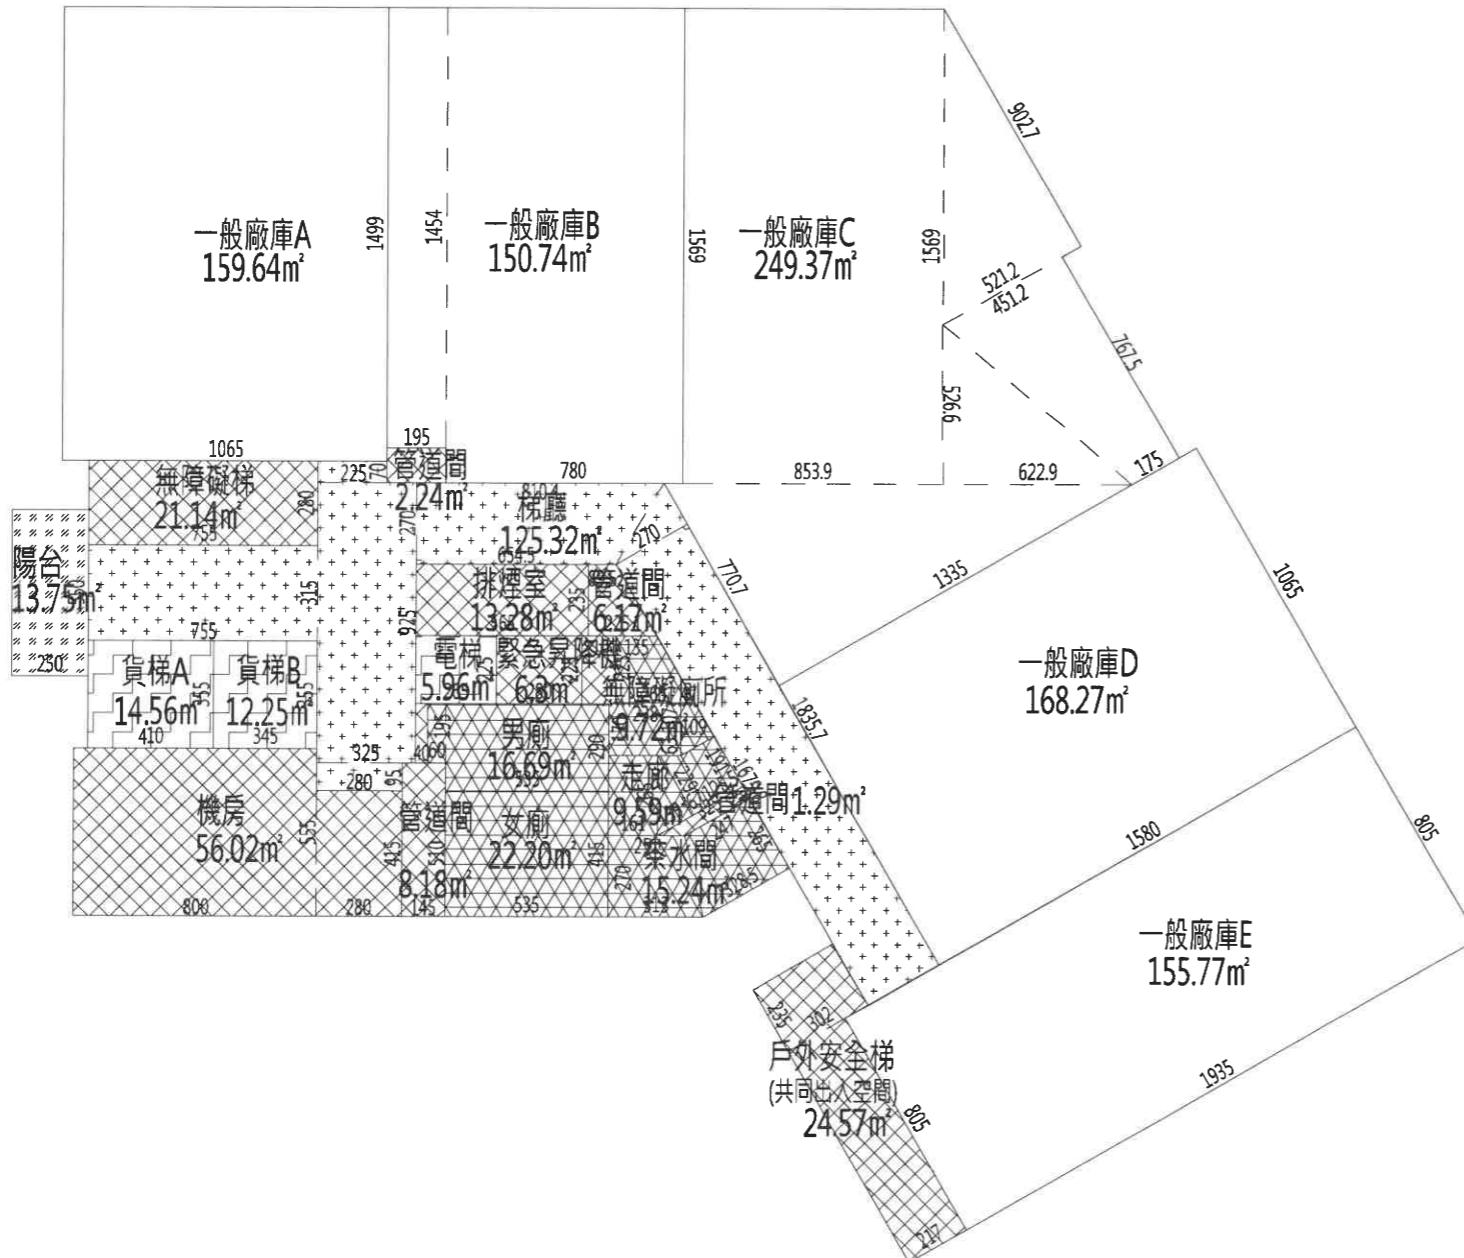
地上四層平面圖(維持原核定)(S : 1/300)
